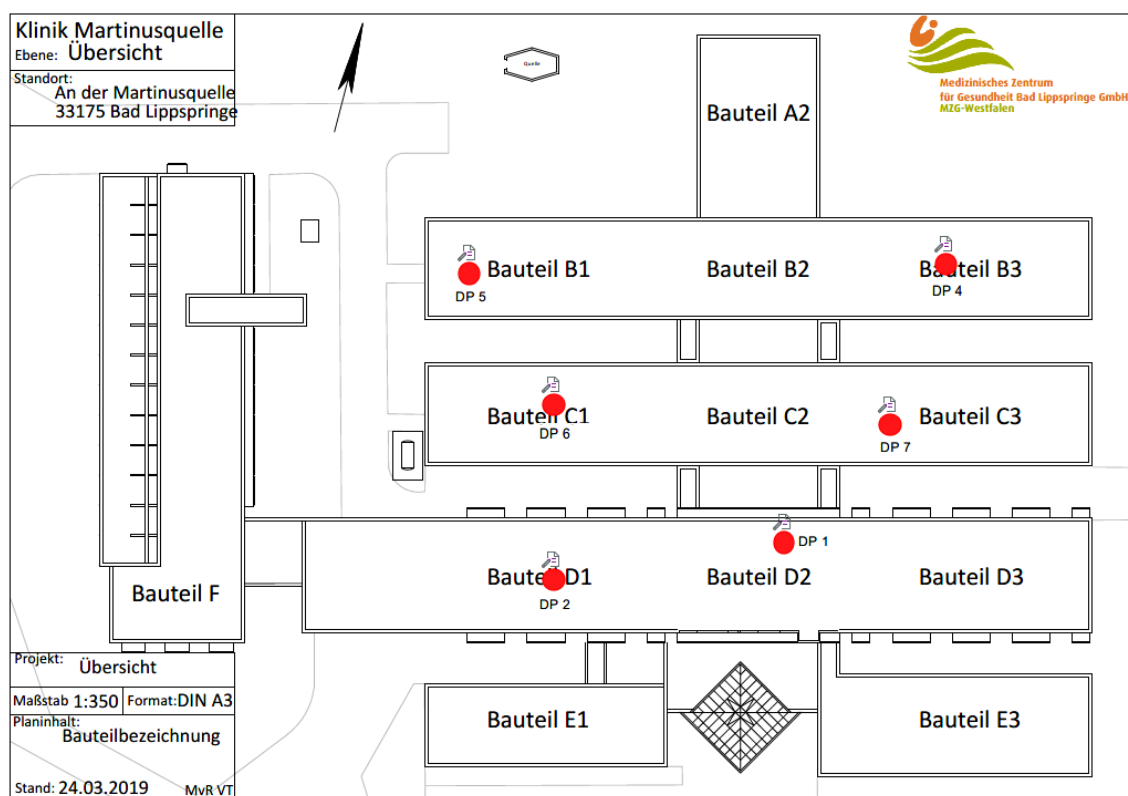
Probennahmepunkte Dachaufbau (nicht eingemessen, ungefähre Lage)
